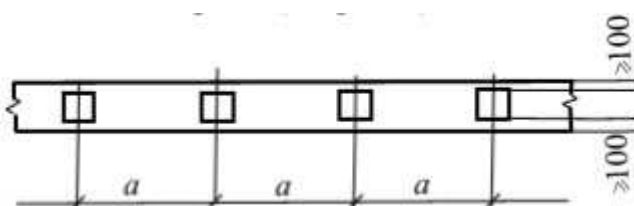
Схема расположения свай в рядовом фундаменте
